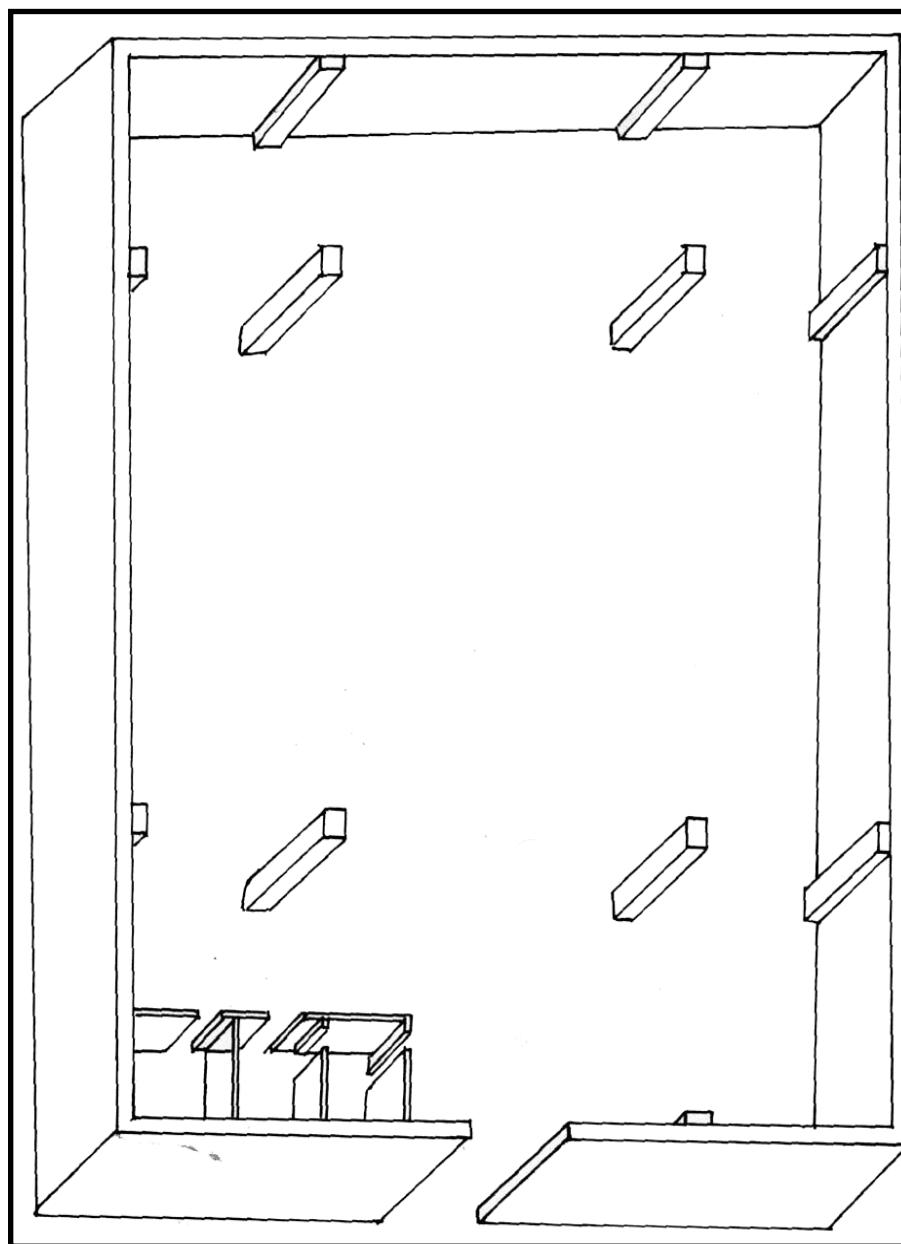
مسقط أفقی للبصمةخانہ من خلال الوثيقة
